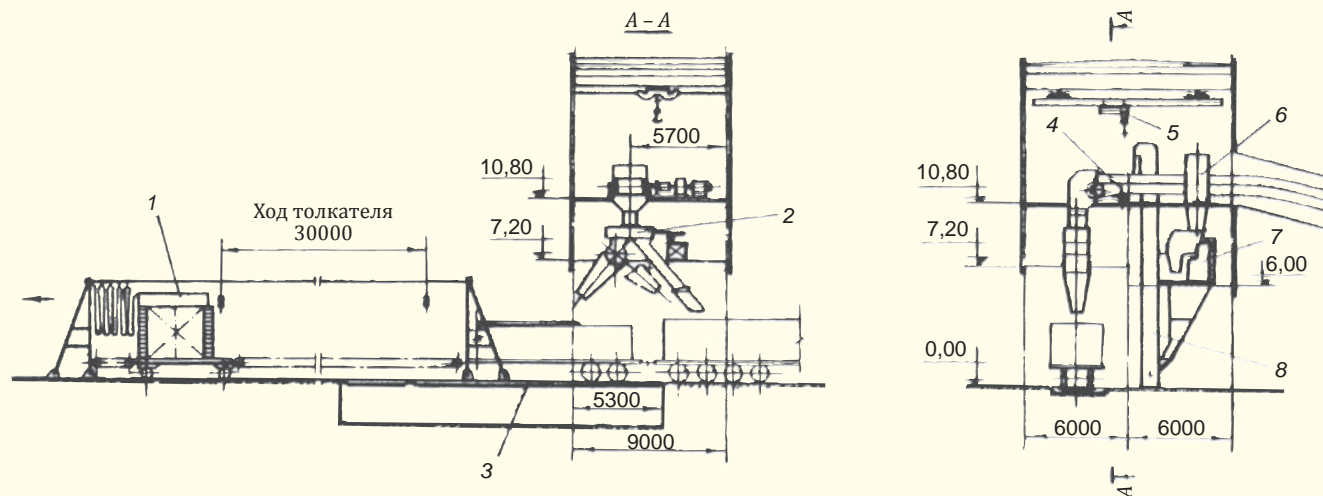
Углепогрузочный комплекс с устройством УП-Р для раздельной компоновки ПСК: 1 – устройство для перемещения вагонов; 2 – погрузочное устройство УП-Р; 3 – вагонные и платформенные весы; 4 – подающий ленточный конвейер; 5 – кран-балка; 6 – пробоотборник; 7 – проборазделочная машина; 8 – элеватор возврата проб.
